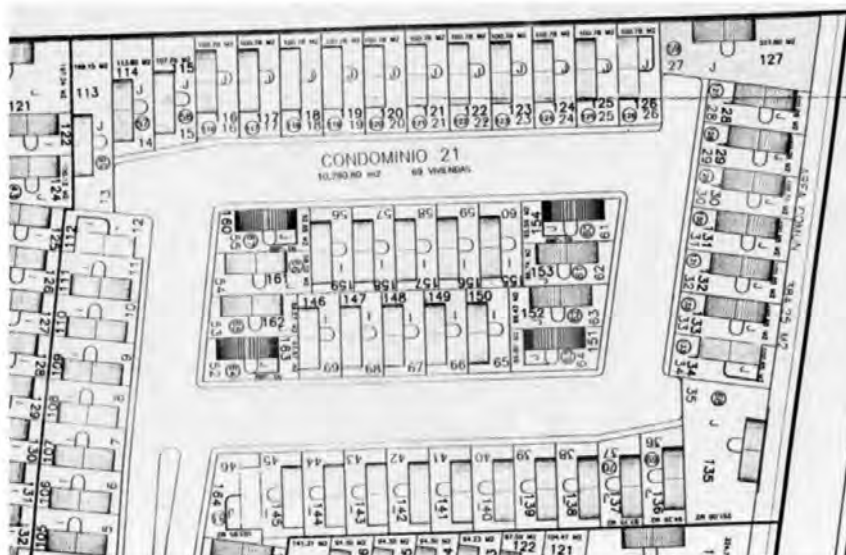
Planta de Conjunto Fraccionamiento Villa de las Flores.
